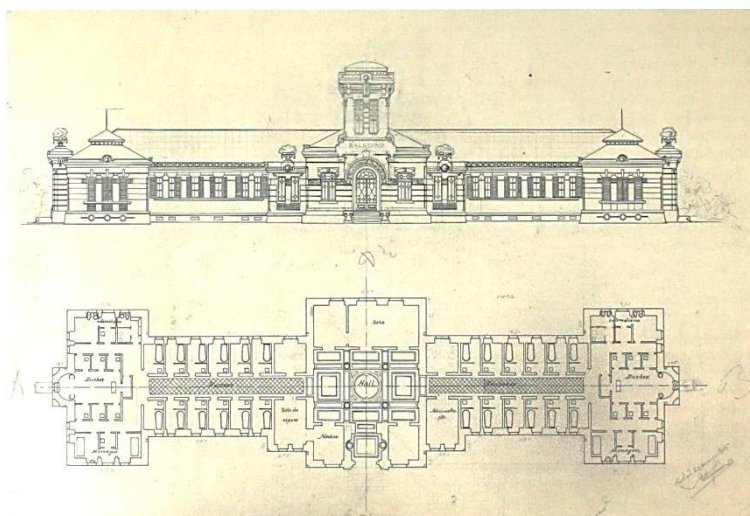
Termas do Vidago, António Rodrigues da Silva Júnior, alçado e planta do projecto do balneário construído, 1915
